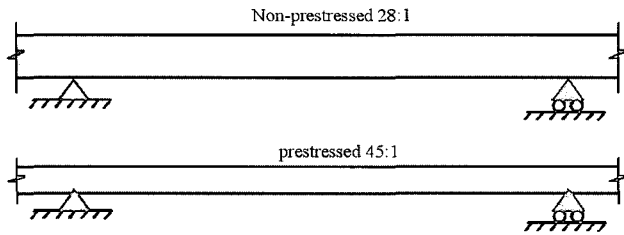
Typical span-to-depth ratios of prestressed and non-prestressed one-way slabs
